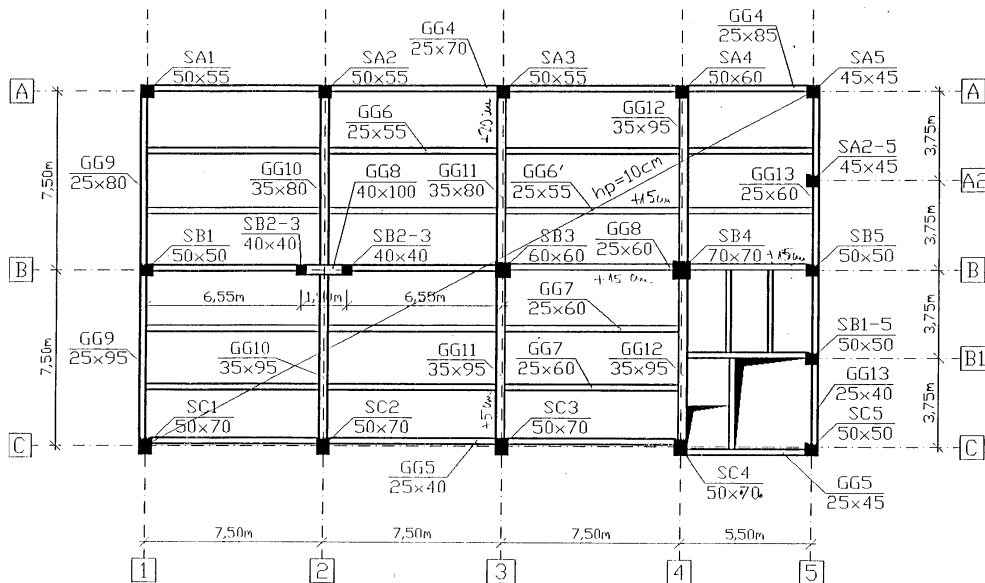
Planșeu cola +10,80m - plan cofraj.
